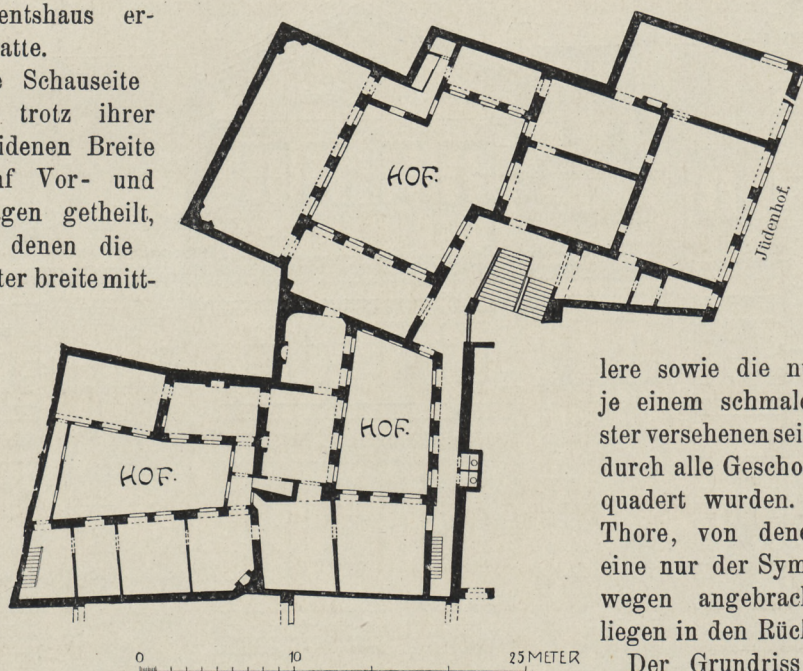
Regimentshaus, Grundriss des Hauptgeschosses.
